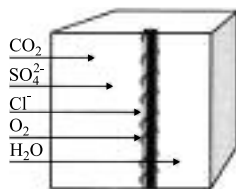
Widok wnikiwania agresywnych substancji w element żelbetowy [1]
